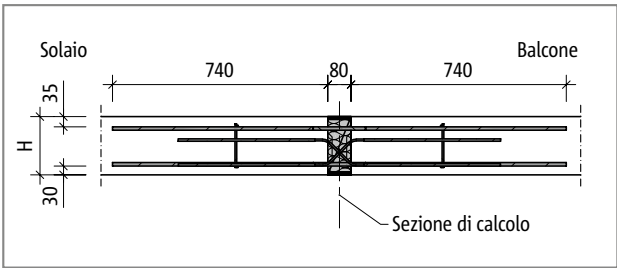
Schöck Isokorb® T tipo DL-CV1: schema statico
